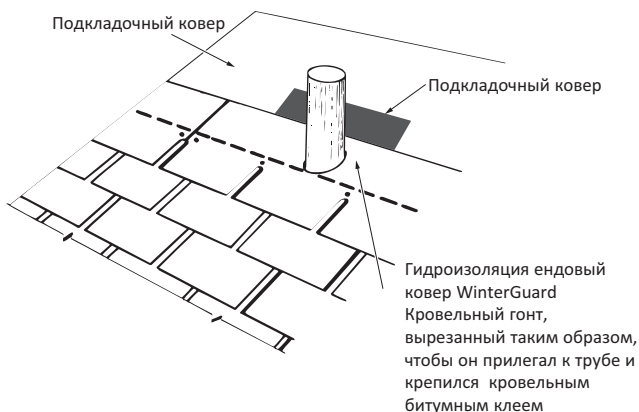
Резка кровельного гонта, чтобы он прилегал к вентиляционной трубе
